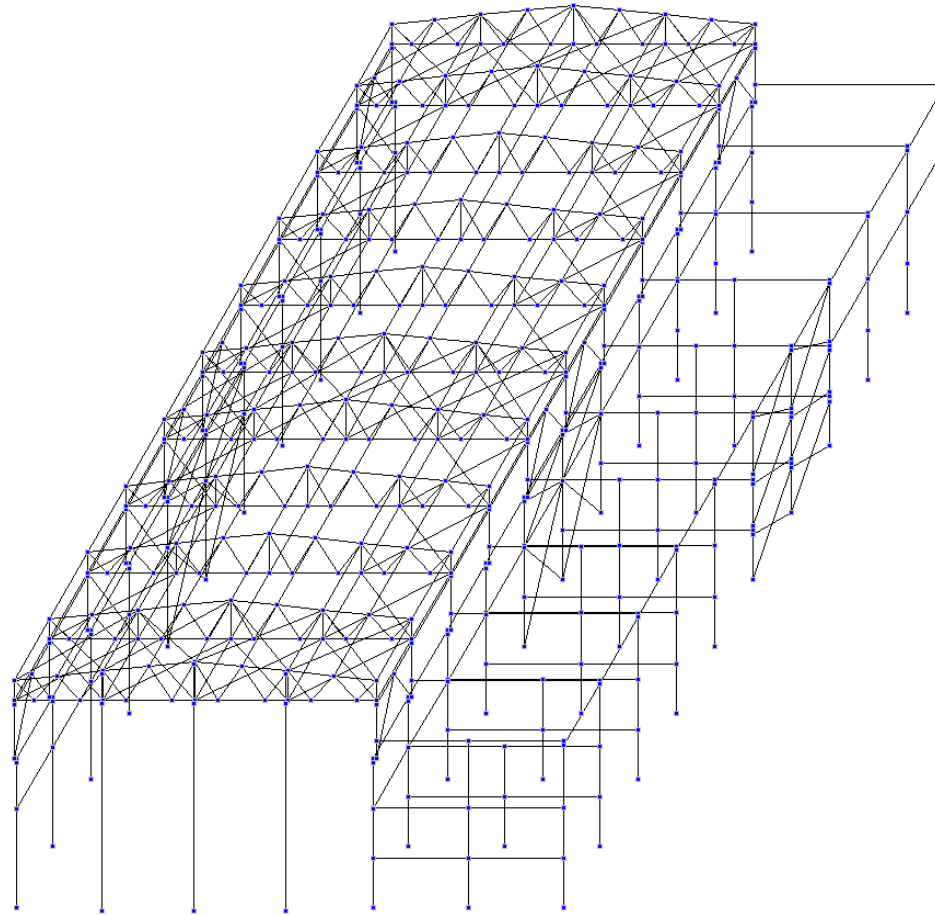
Общий вид расчетной схемы каркаса здания
